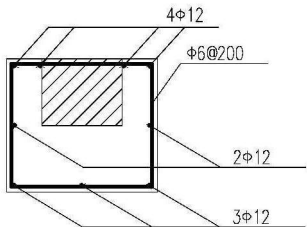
混凝土构造柱加固示意图(阴影部分为原混凝土柱)
